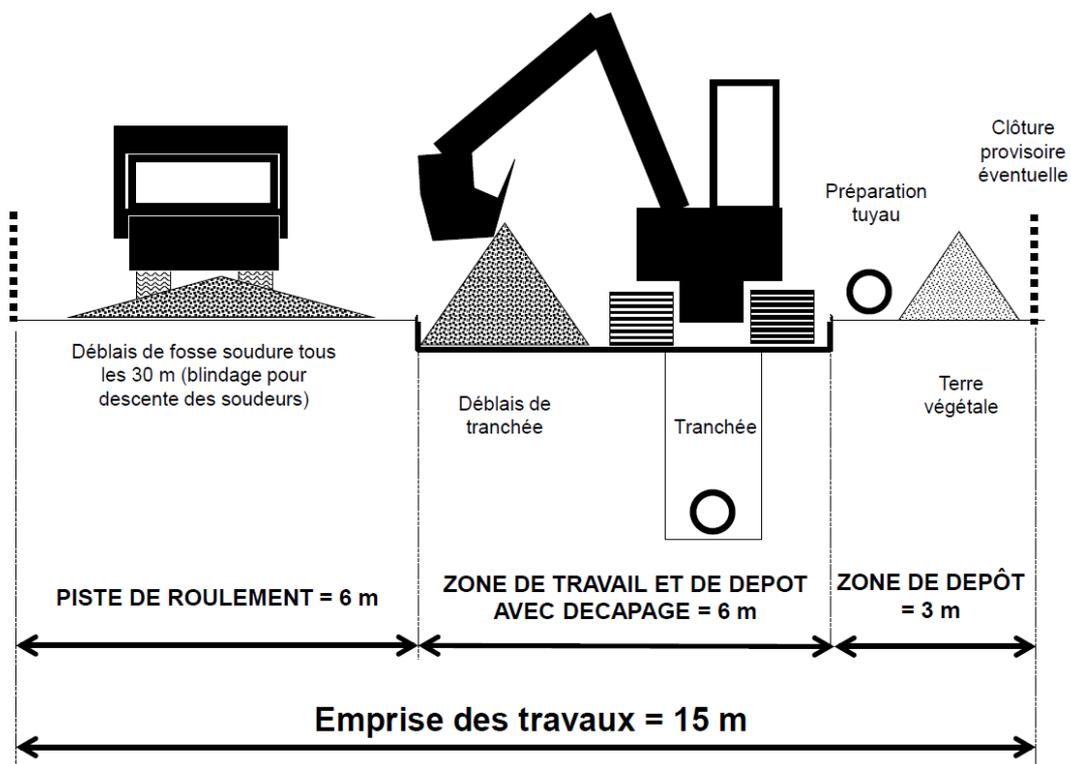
Schéma des travaux en zone agricole (source : SETEC hydratec)
